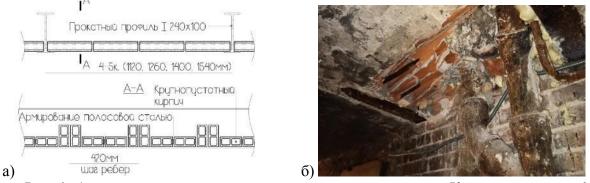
a) – несущая конструкция междуэтажного перекрытия Клейна, пролет до 6 м (схема), б) – надподвальное перекрытие, тип 1 (фото)
